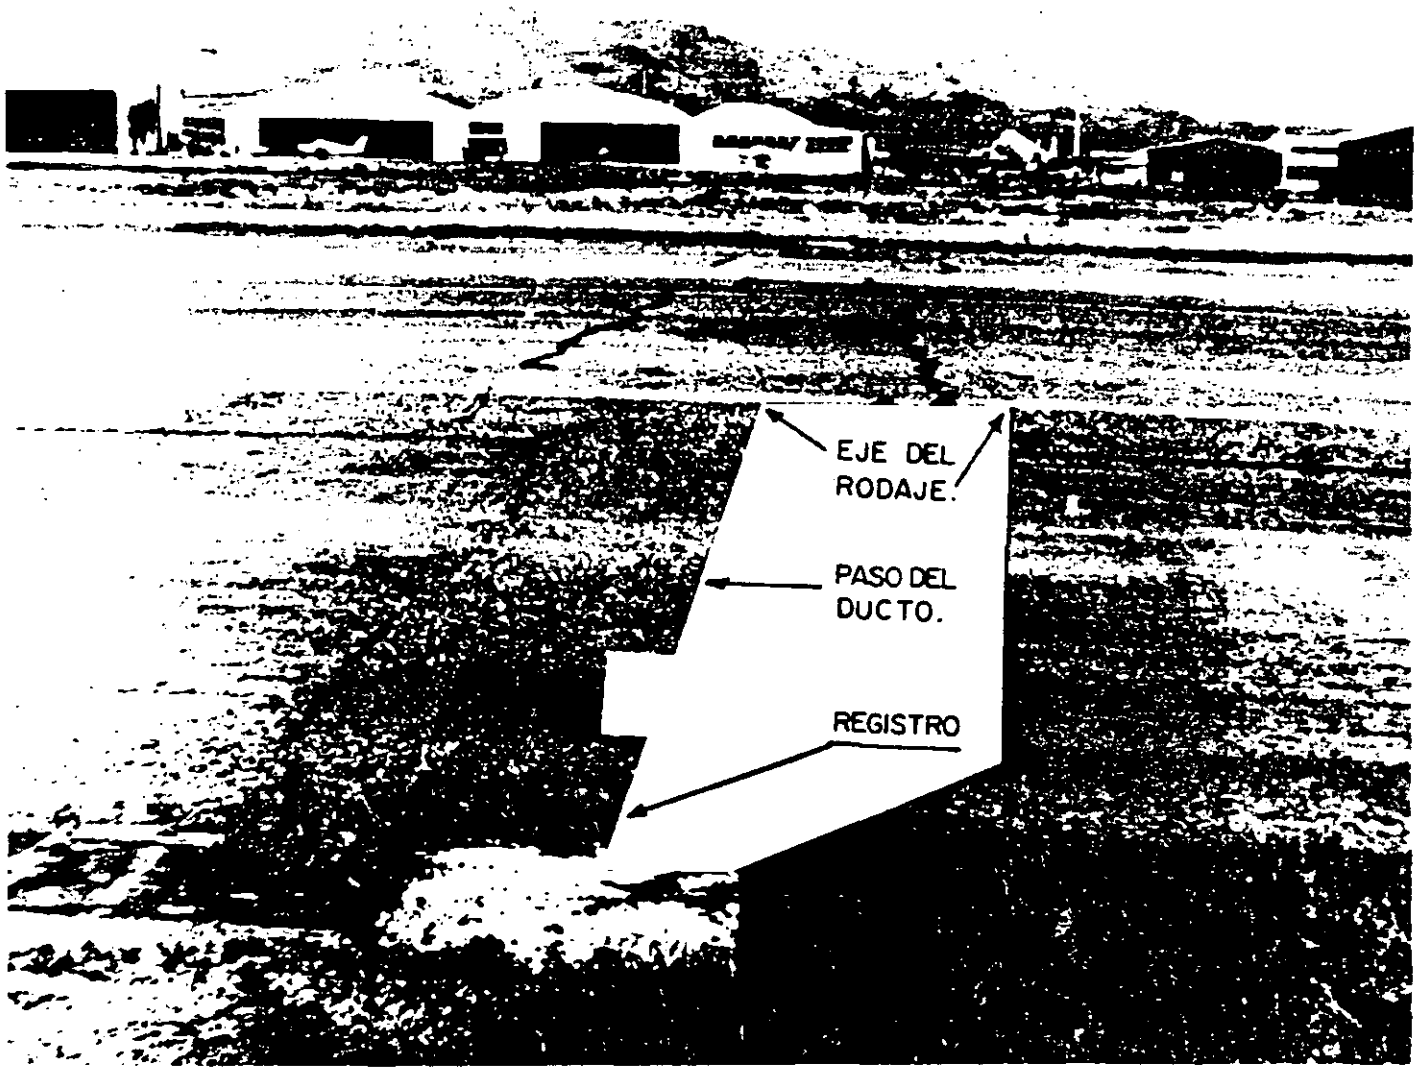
32 Grietas transversales en la zona de pavimento cruzado por un ducto
